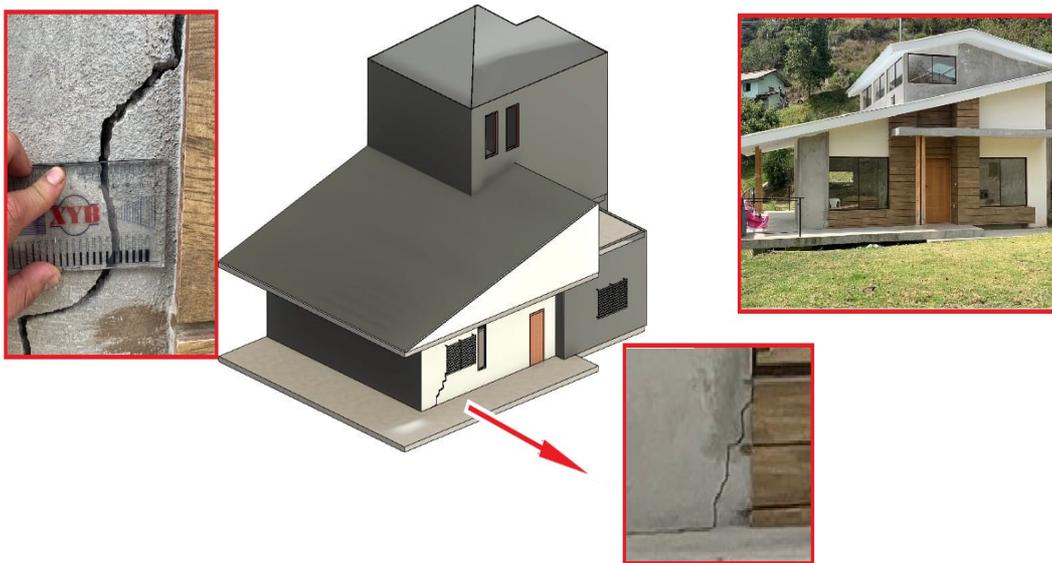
Casa 14. Detalle de fisuras en vivienda nueva.
